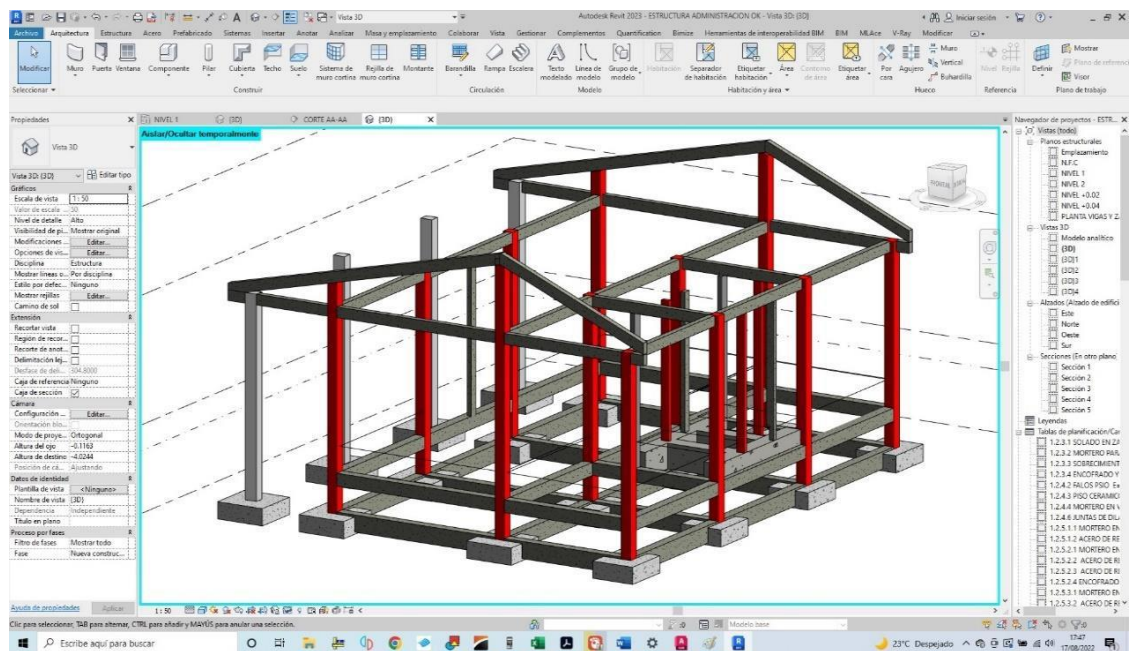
Elevación frontal, vista de zapatas conectadas, vigas de cimentación y sobrecimiento armado.
